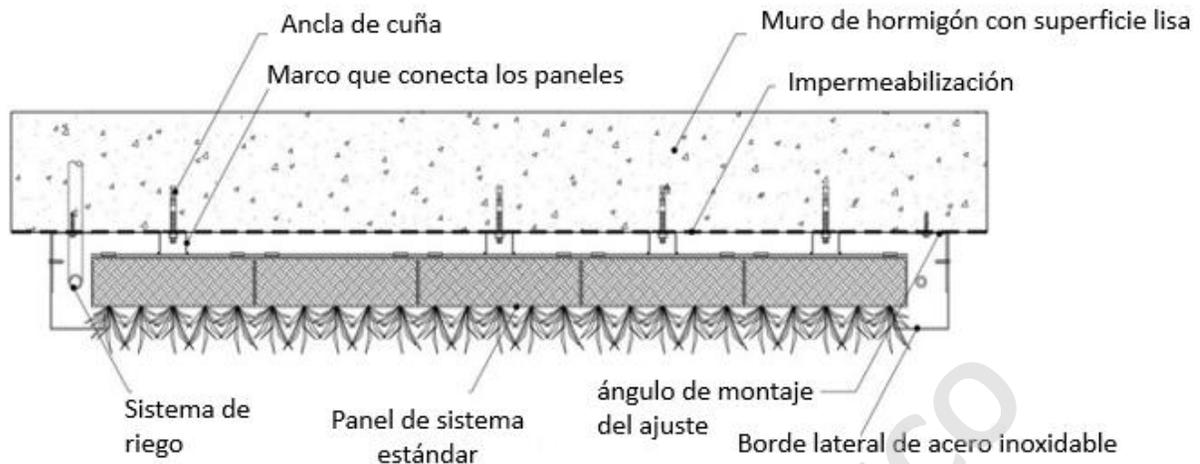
Construcción de sistema modular de muro verde, sección horizontal.
